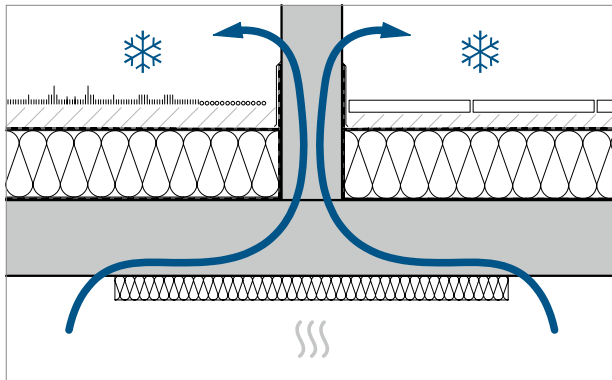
Pos ③: Wärmefluss bei Dachaufbau mit Flankendämmung
